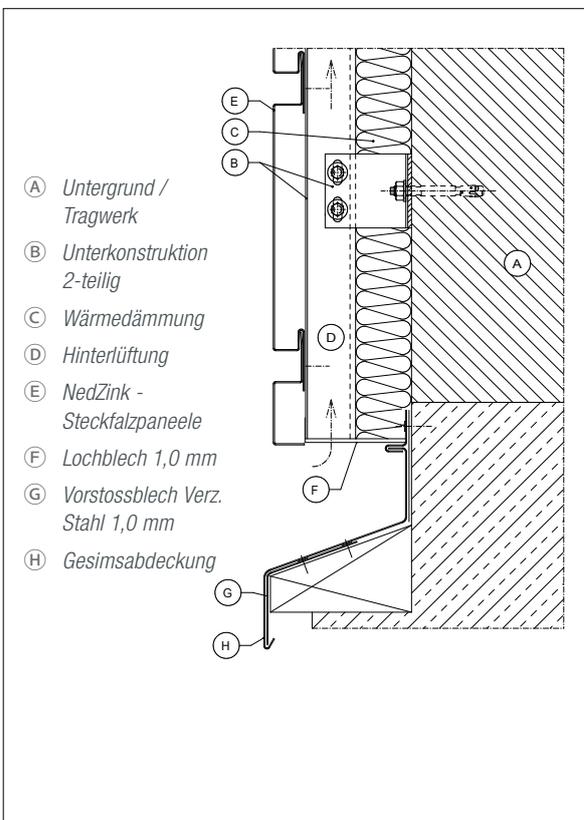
Steckfalzpaneele Unterer Fassadenabschluss
